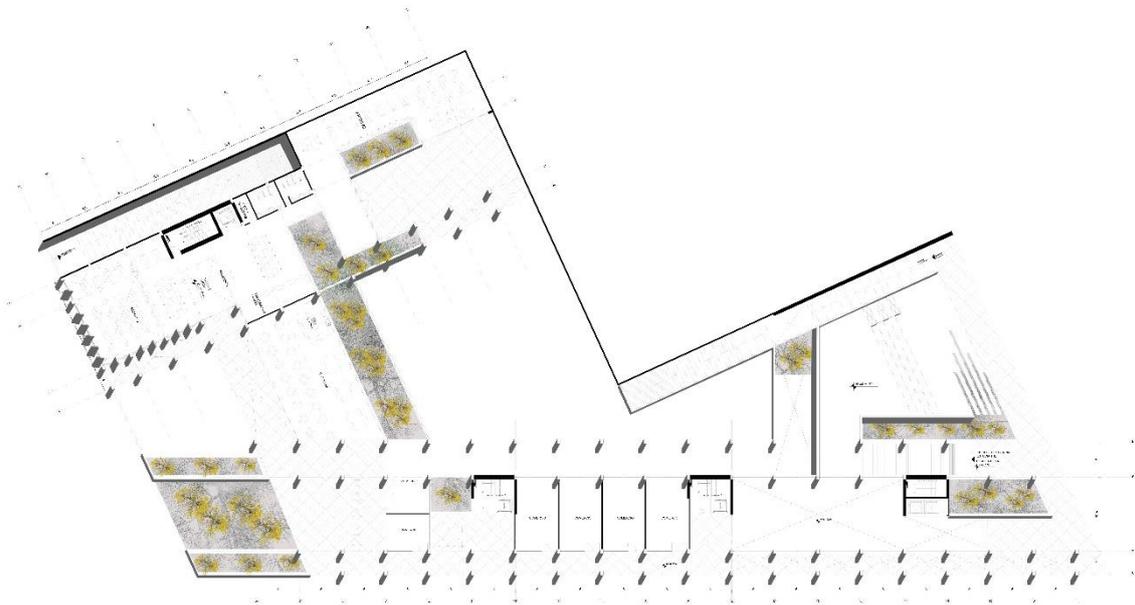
Planta Baja. Nivel + 0.00. Elaboración propia.
